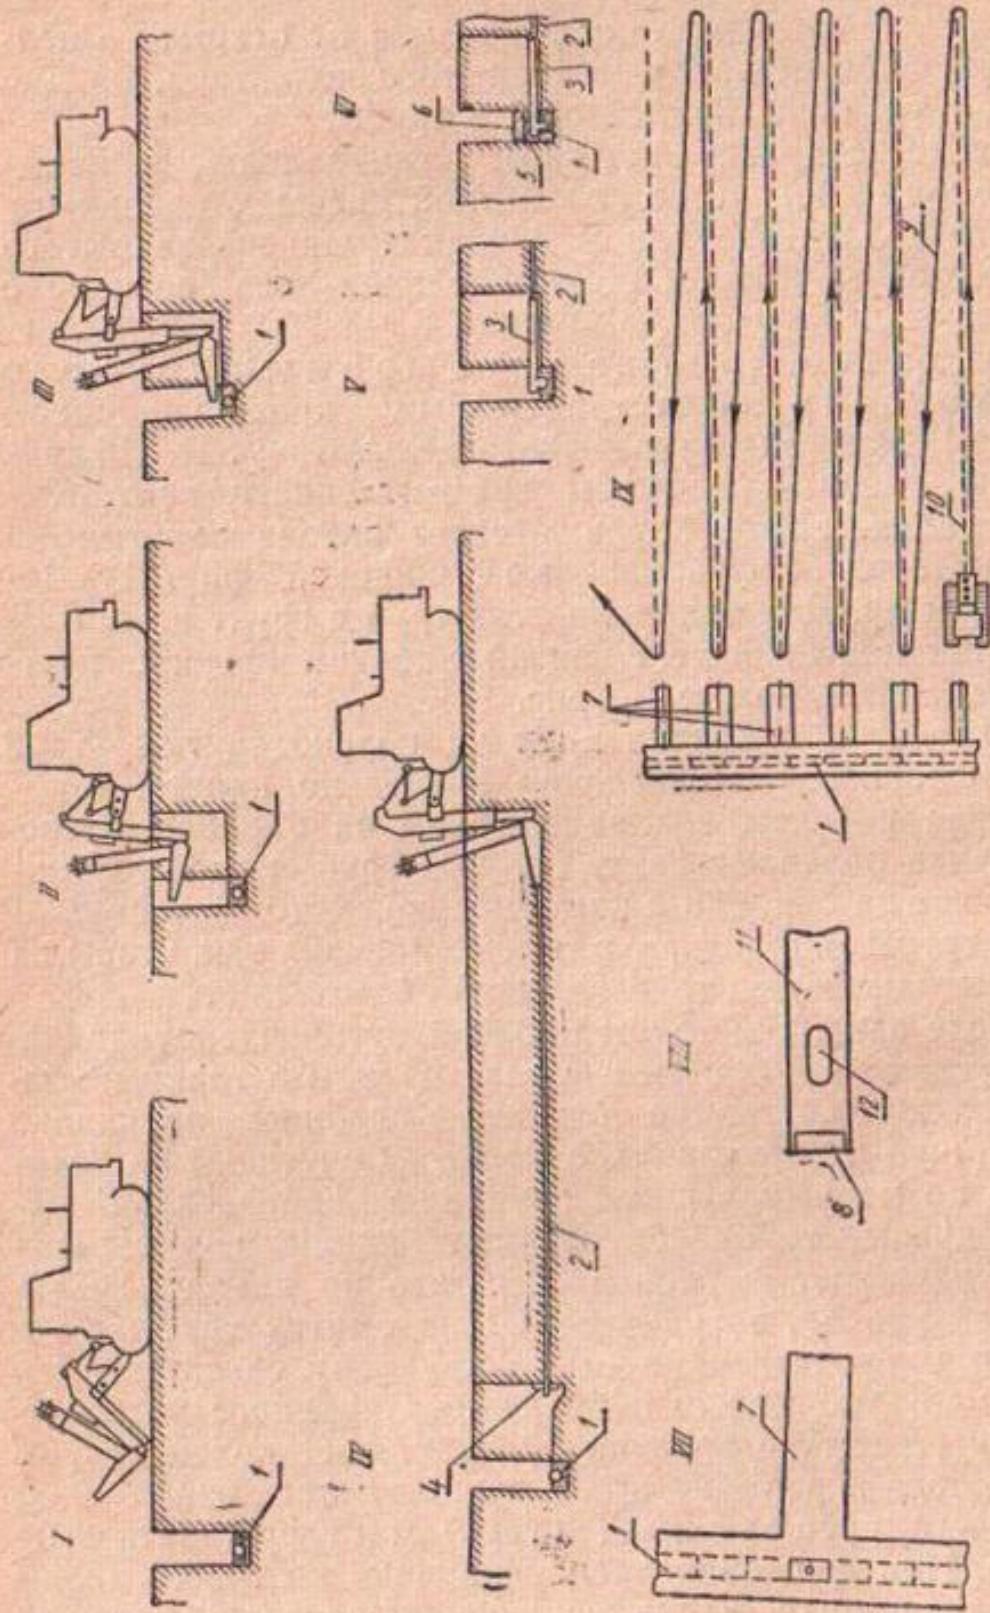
Схема бестраншейной закладки пластмассовых дрен:
